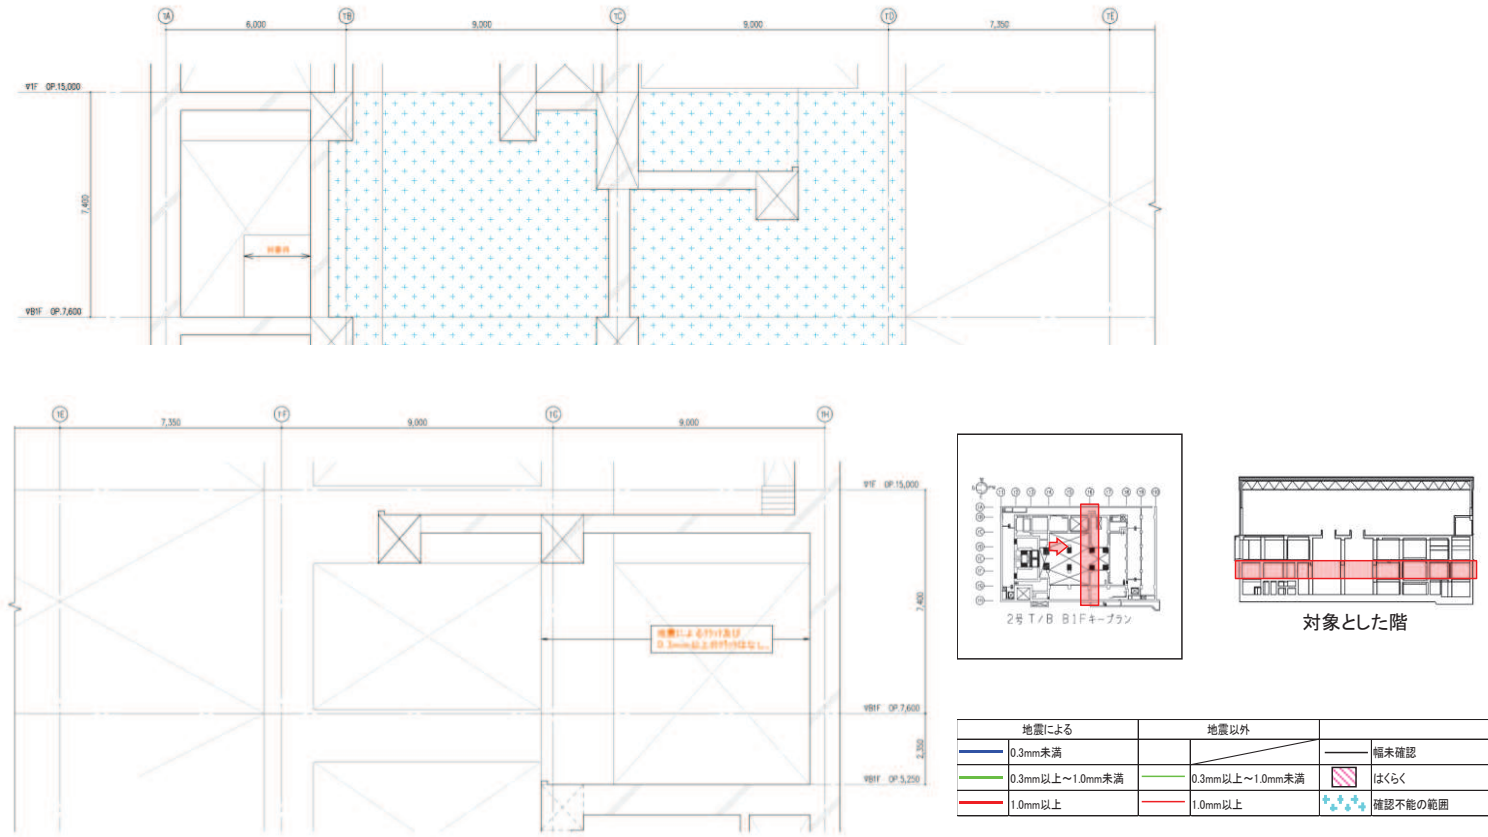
タービン建屋のひび割れ分布 耐震壁 (22) 地下 1 階 T6 通り
